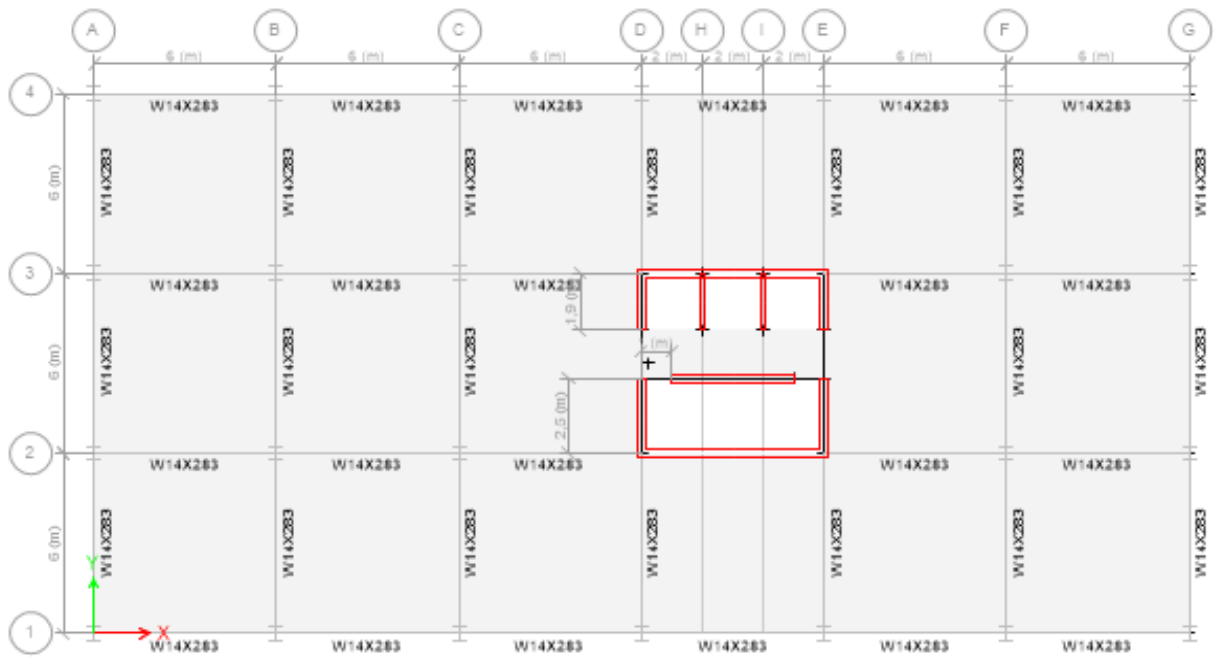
13: Vista en planta de las vigas correspondiente a los pisos 1-6, edificio tipo C.
